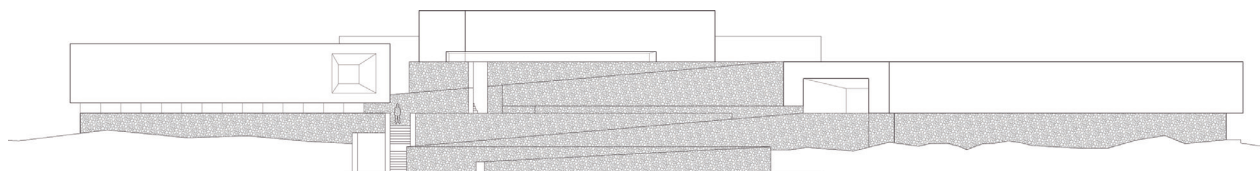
Planimetría preliminar del proyecto (sujeto a modificación).
